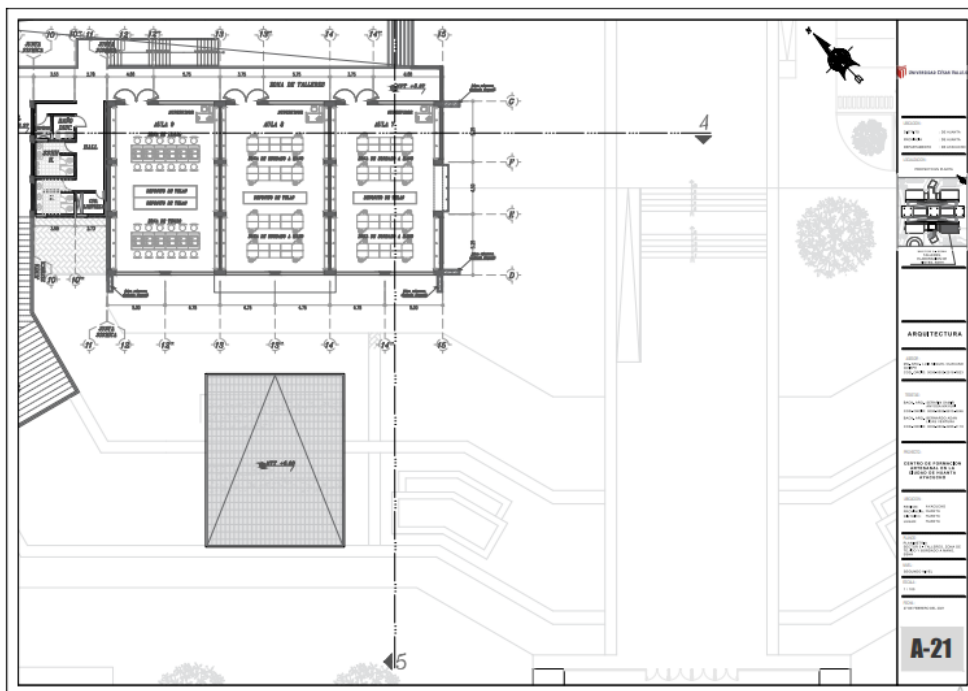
Planimetría del sector 5 ubicado en el piso 2. Escala 1/100.
